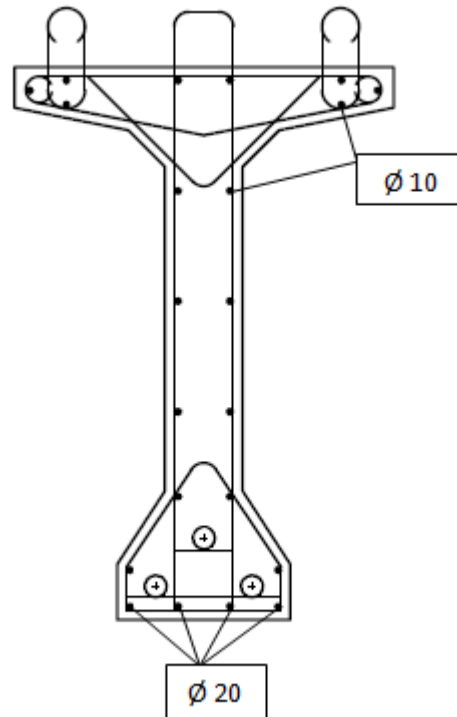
Ferrailage de la poutre en BP a la zone médiane.
